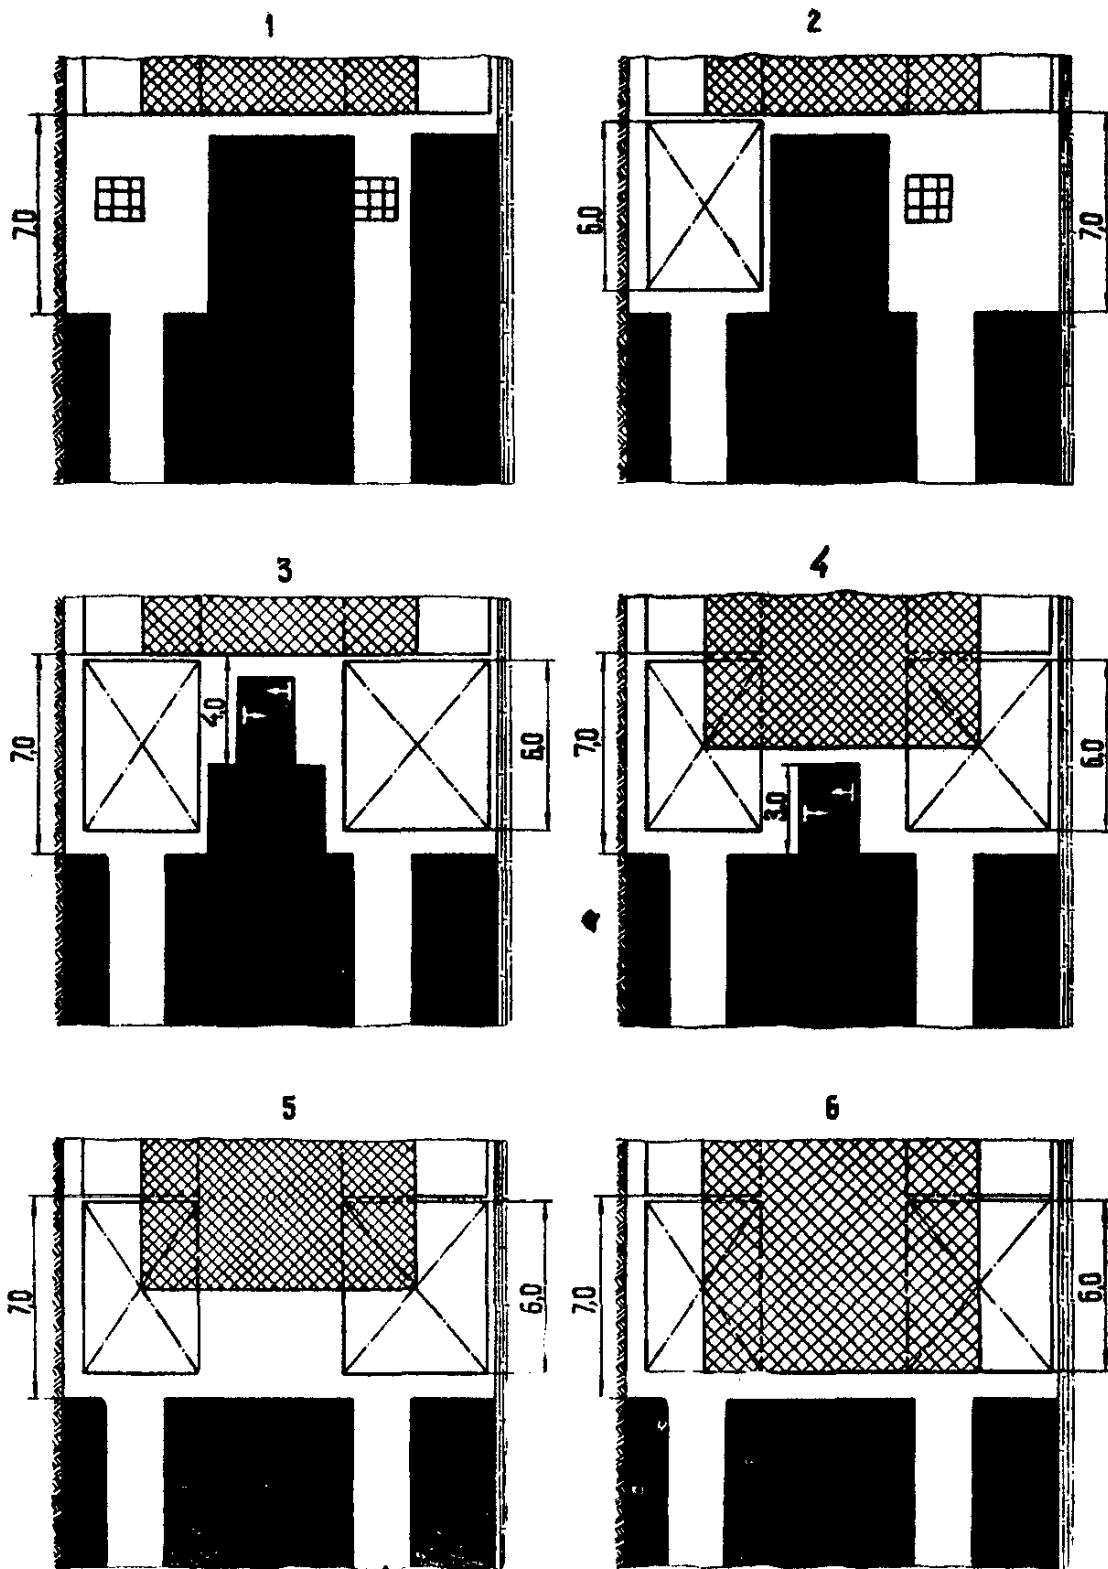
Порядок проведения монтажных камер и монтажа звеньев комбинированного перекрытия
